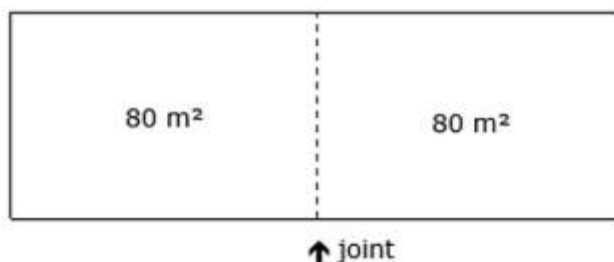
Fractionnement de la chape en cas de plancher chauffant
